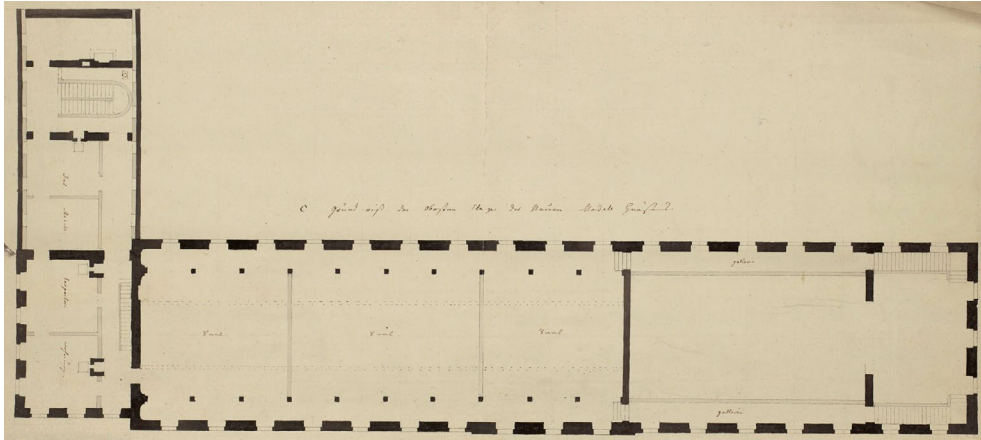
Simon Louis Du Ry, *Entwurf für ein neues Modellhaus*, Grundriss des Obergeschosses, 1780.
